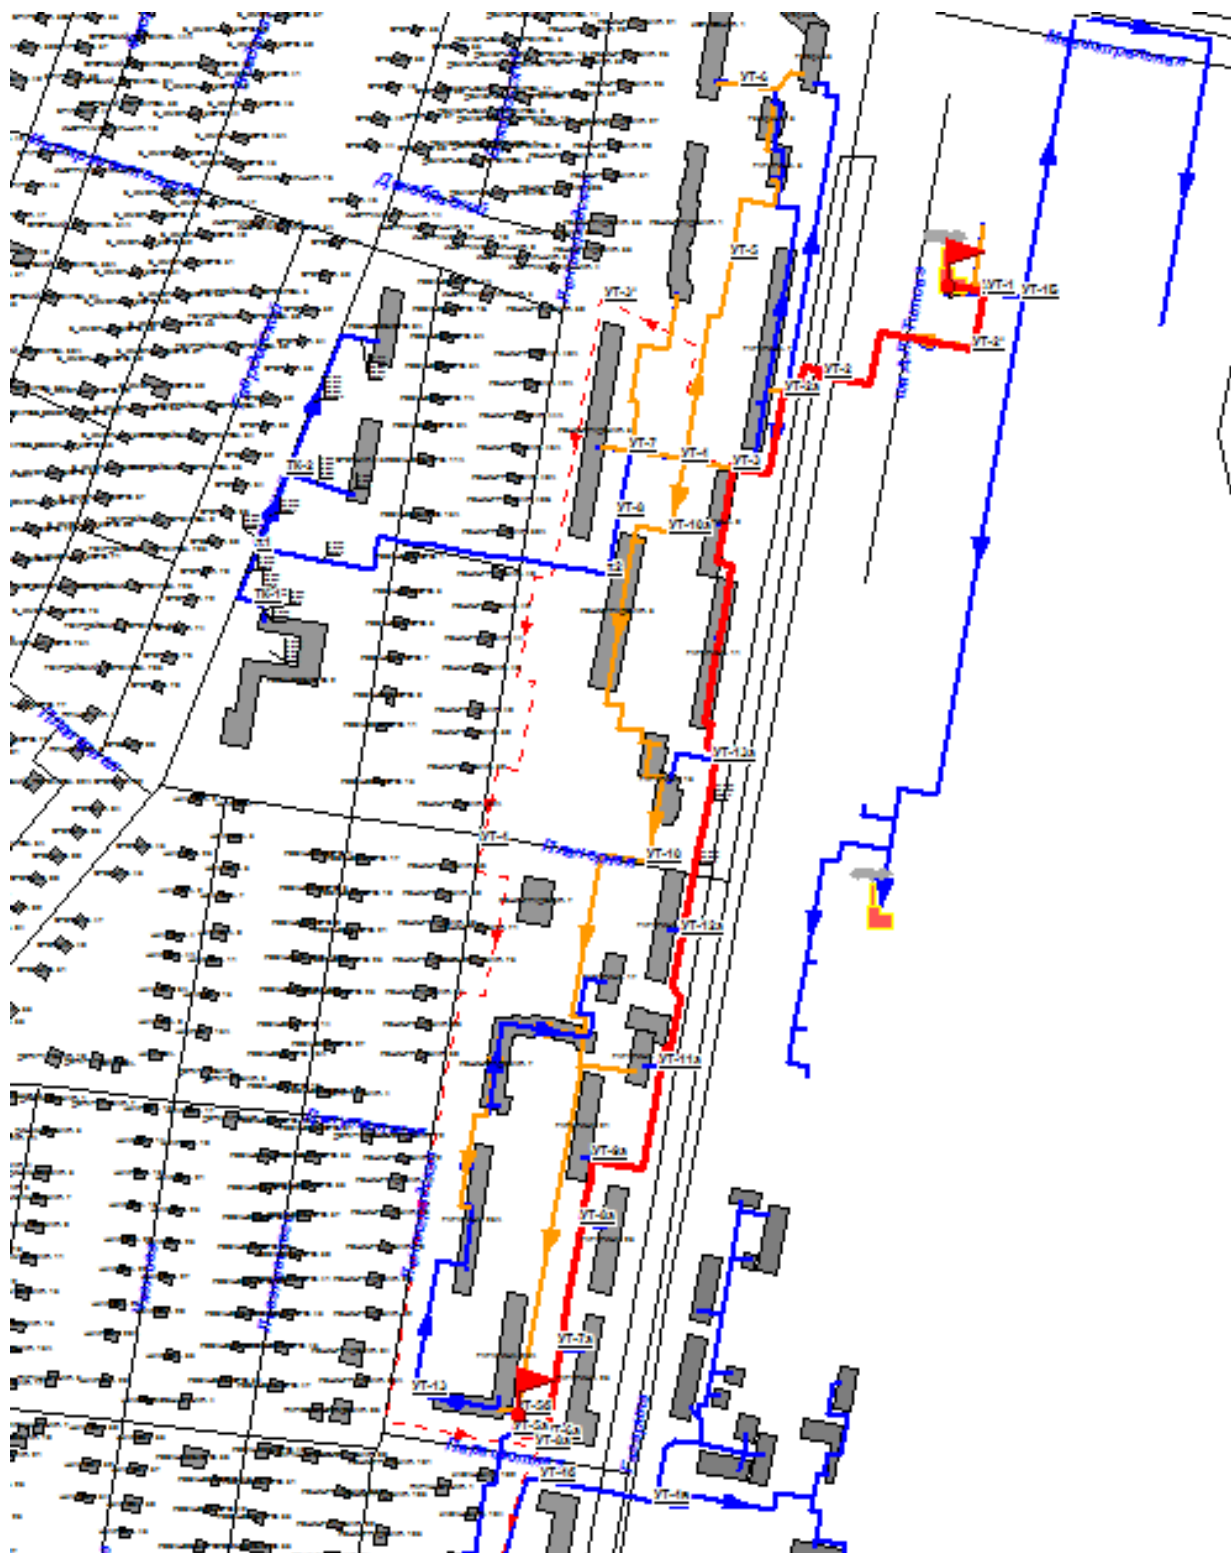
Расчетная схема участка тепловой сети от котельной Дружбы 2В ООО «УКС» до УТ-56
